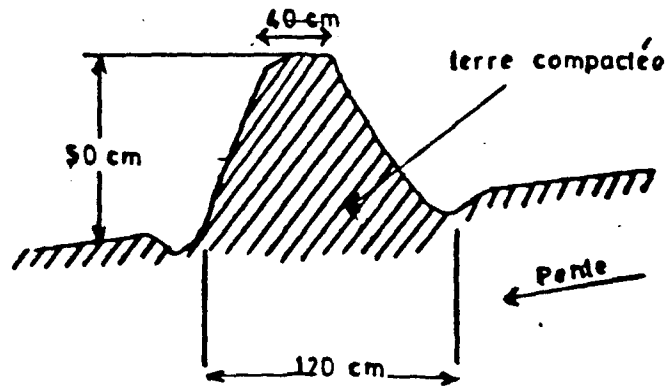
COUPE TRANSVERSALE D'UNE DIGUETTE
